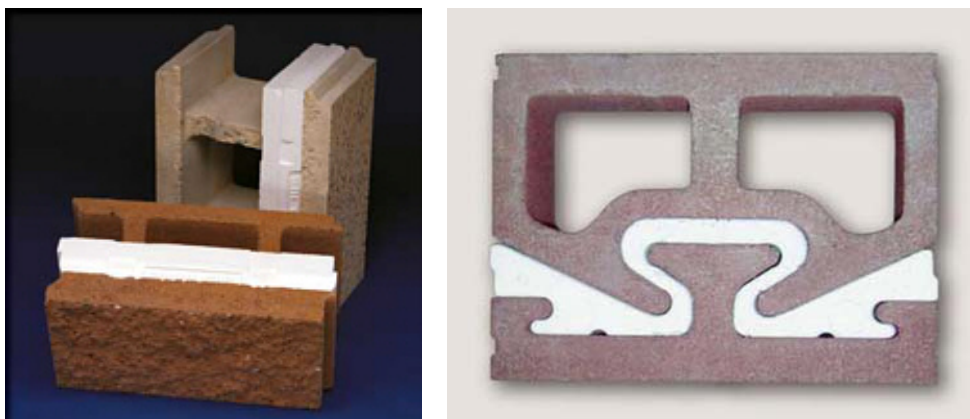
Muestras de bloque con aislante térmico entre dos piezas de hormigón.
